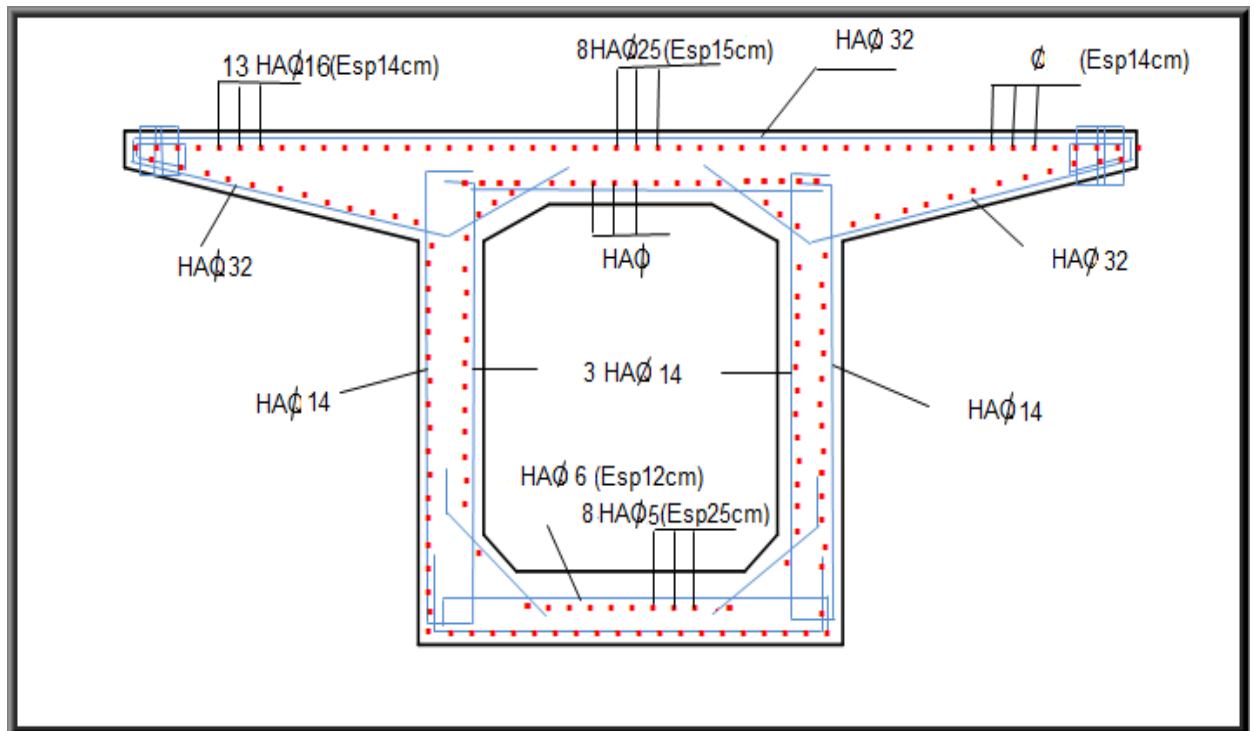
Schéma du Ferrailage du voussoir près de la pile.
